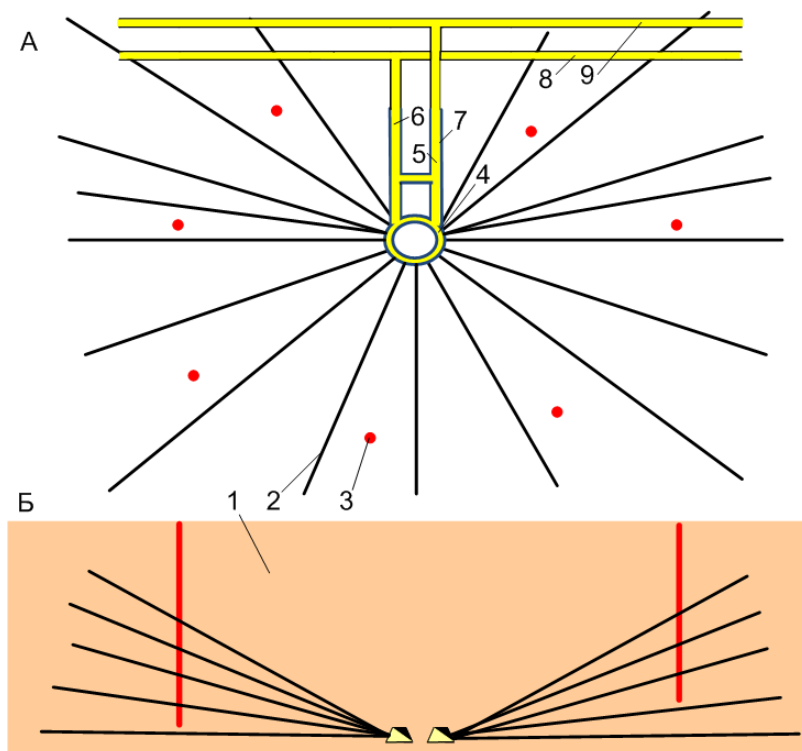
Подземно-поверхностная система разработки с теплоизоляцией и гидроизоляцией выработок нефтяного пласта
